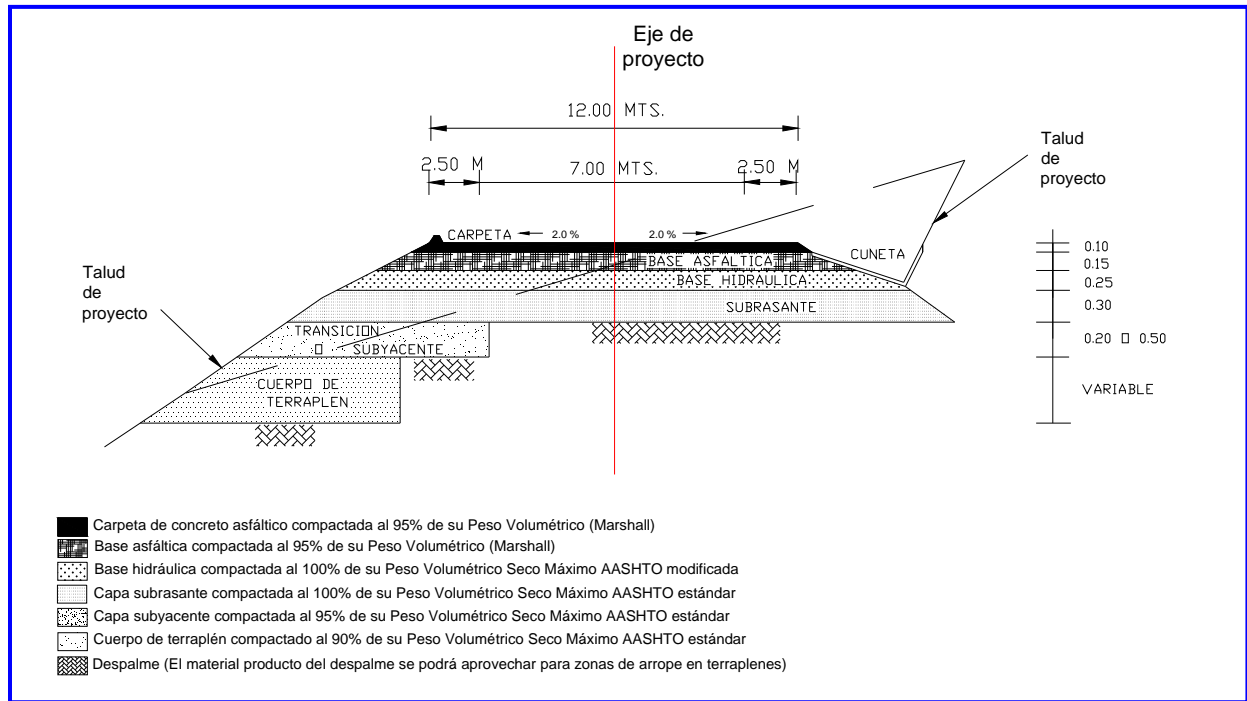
SECCIÓN ESTRUCTURAL TIPO (EN BALCÓN)
